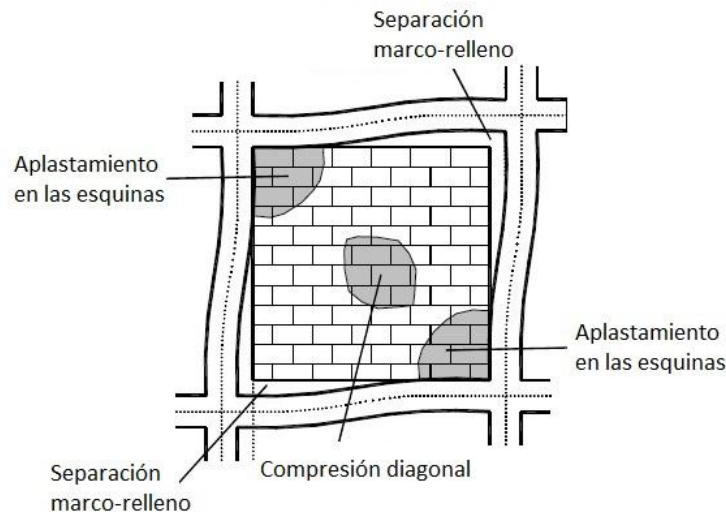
Aplastamiento en las esquinas y compresión diagonal en el panel de mampostería
